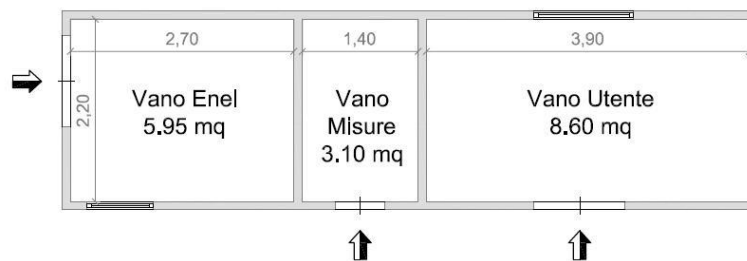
Planimetria Stato di Fatto Foglio 39, p.lla 374, Piano Terra.
